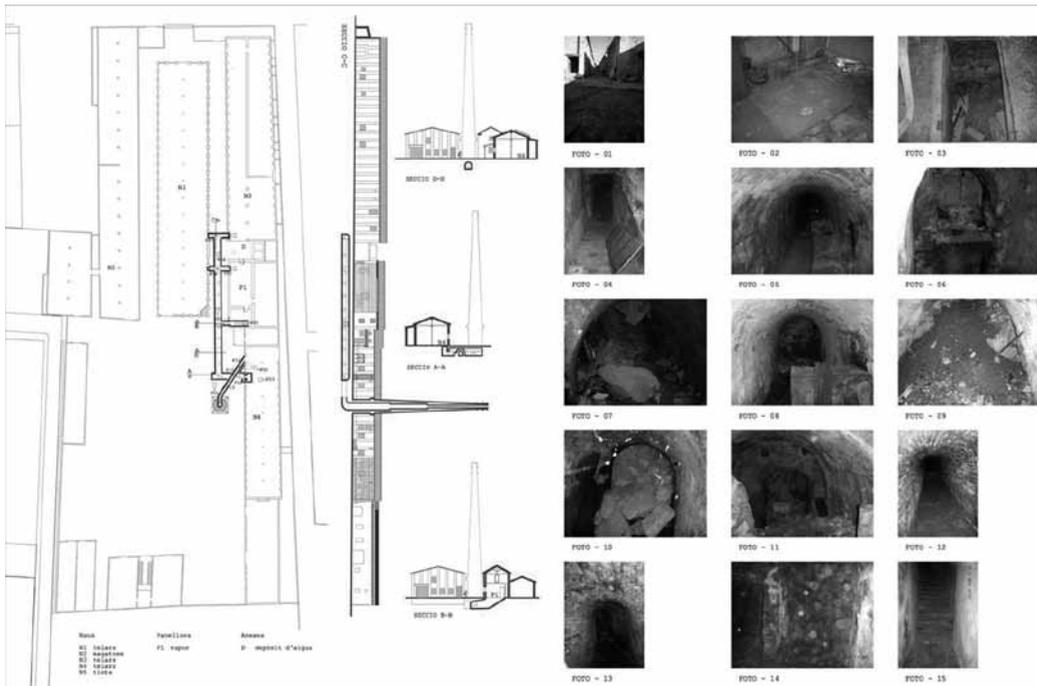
Galerías de conexión del pabellón del vapor con la chimenea y naves.
